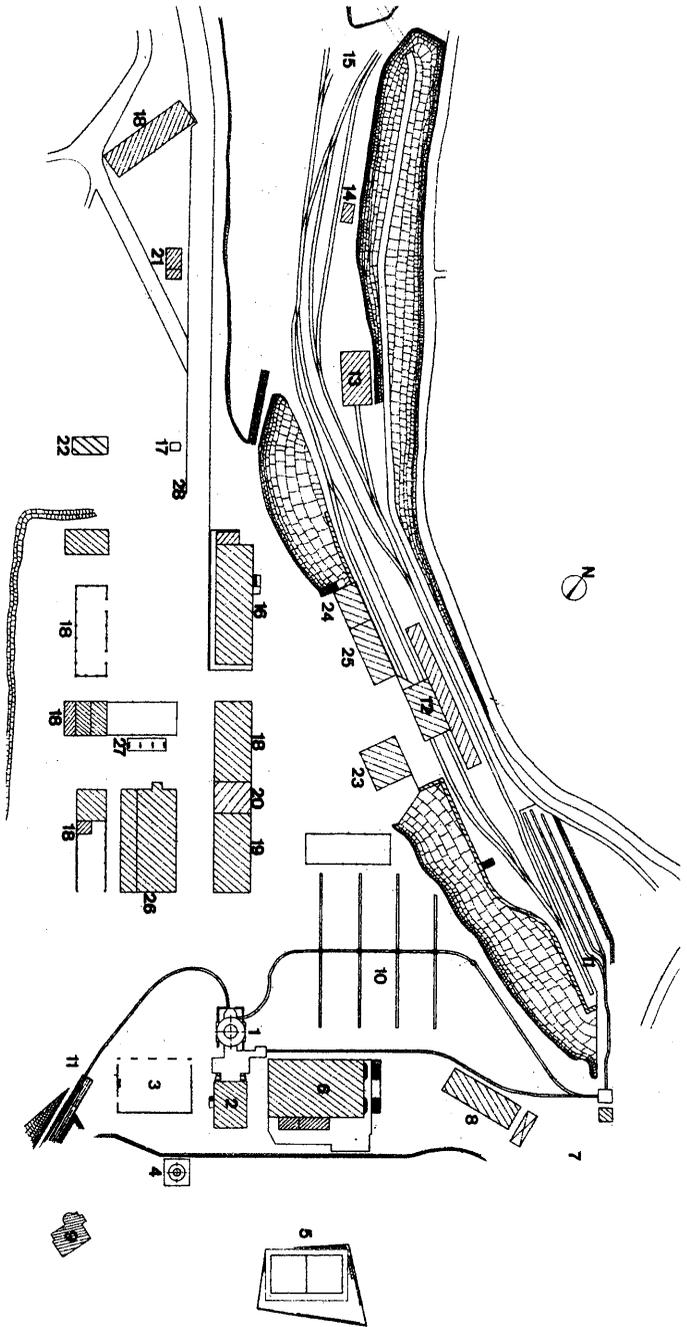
Plano de las instalaciones de superficie, 1925. (*Services généraux. Installations générales Lieres. Plan d'ensemble des installations de surface*). Lieres, 15-12-1925, firmado G., escala 1:200 en el original. Archivo Solvay Lieres. Calco de Minerva Álvarez. LEYENDA: 1 Pozo n.º 1. 2 Sala de la máquina de extracción. 3 Generador, antes sala de calderas. 4 Chimenea. 5 Depósitos de agua. 6 Central eléctrica.
